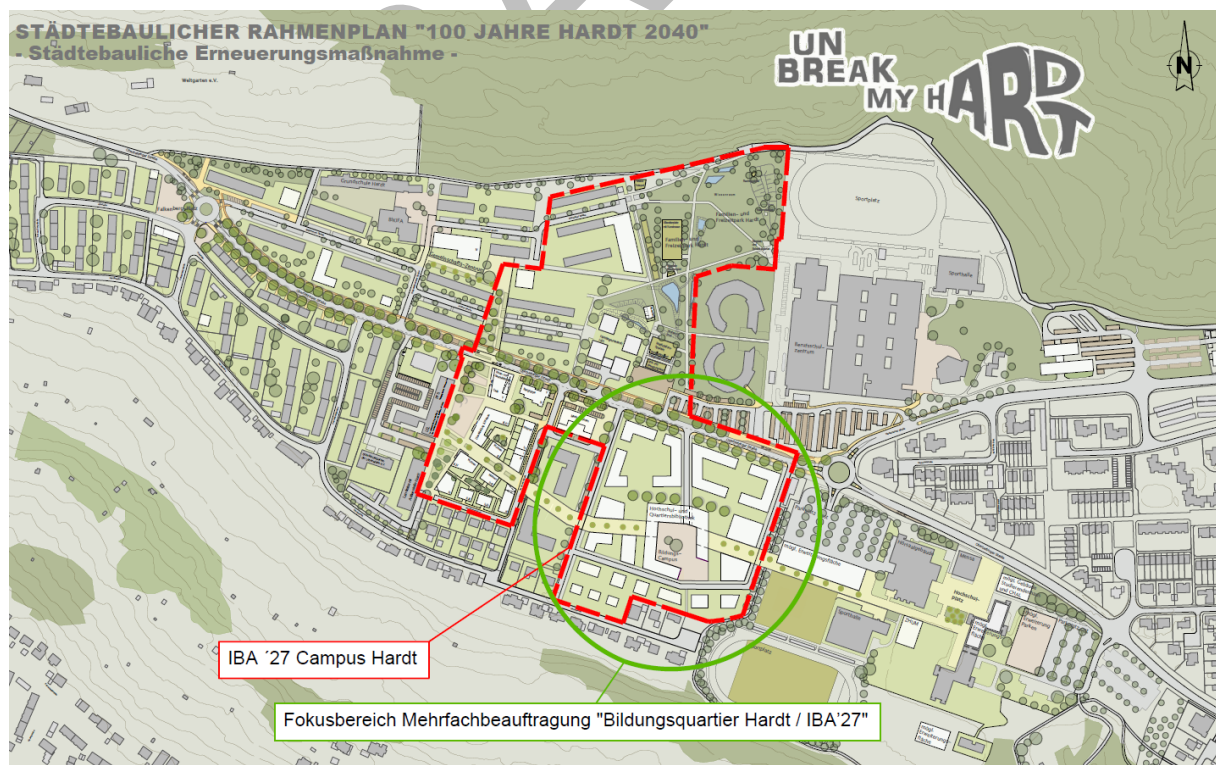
Städtebaulicher Rahmenplan „Unbreak my Hardt“ © Stadt Schwäbisch Gmünd
